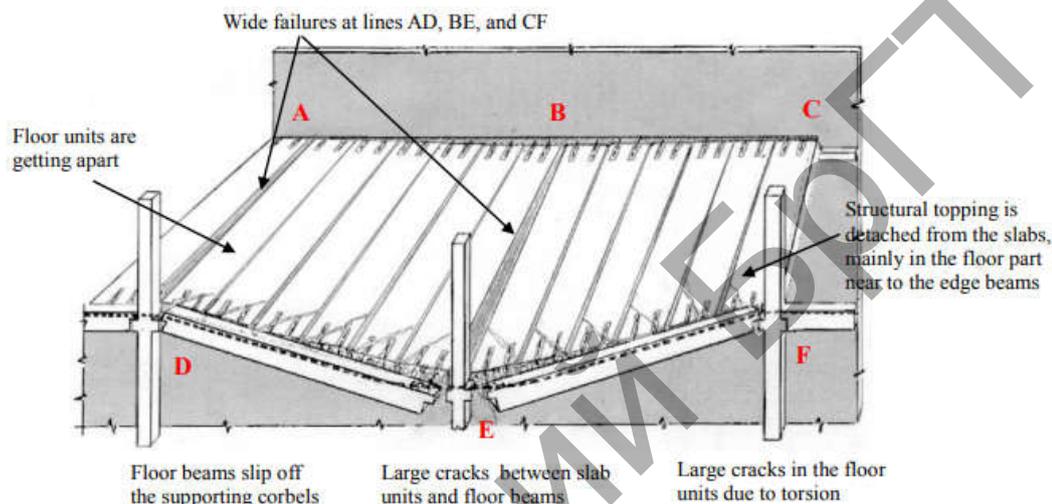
Возможное поведение конструкций в случае отказа средней колонны крайнего ряда конструкции [10]
